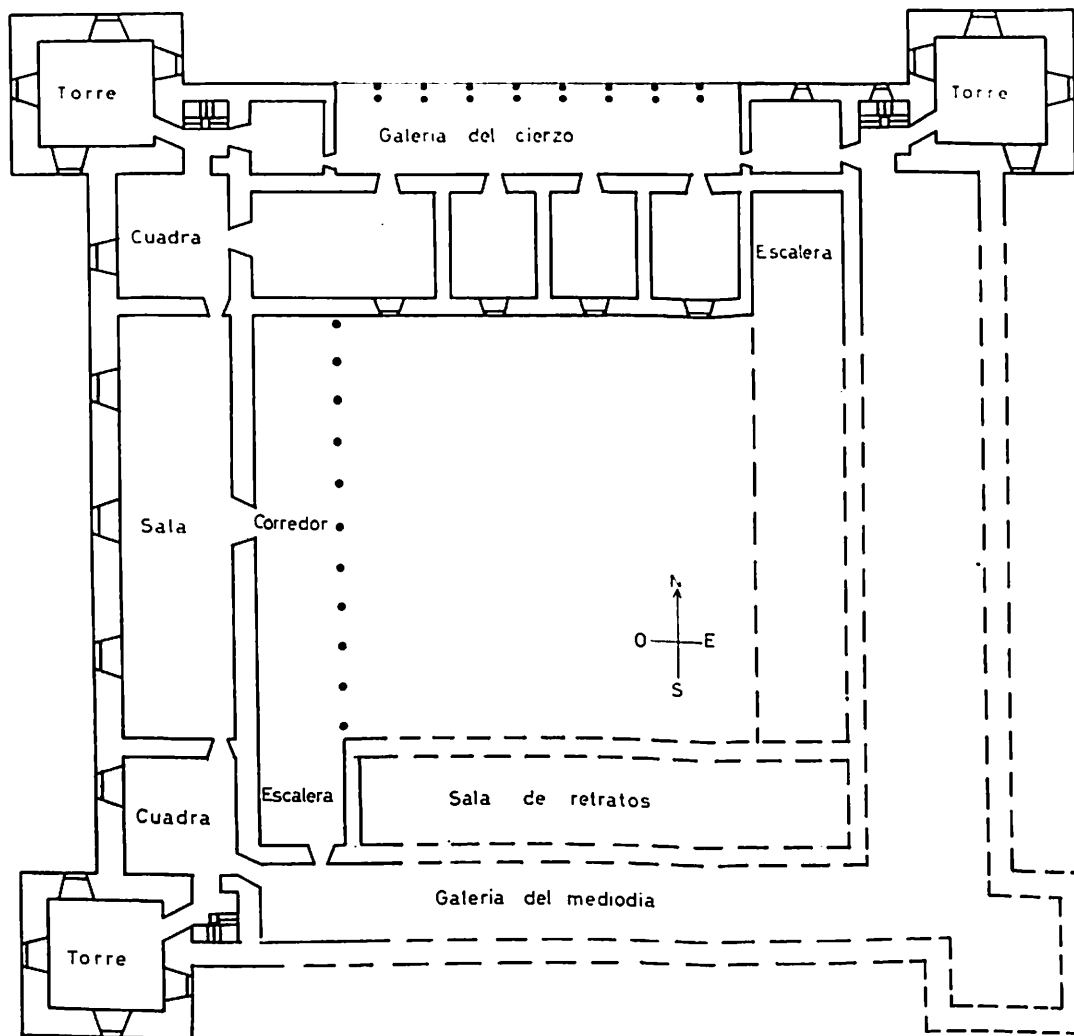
Diseño de la planta principal del palacio de El Pardo, indicando el estado de las obras en 1548.
